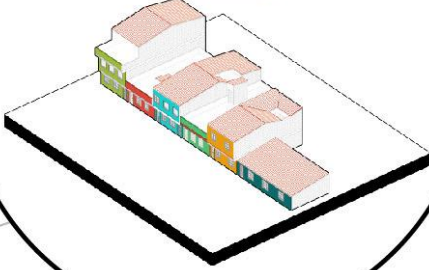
Estado actual del entorno adyacente al edificio ubicado sobre la avenida Caracas con calle 60, en la zona central – norte. *Elaboración propia.
